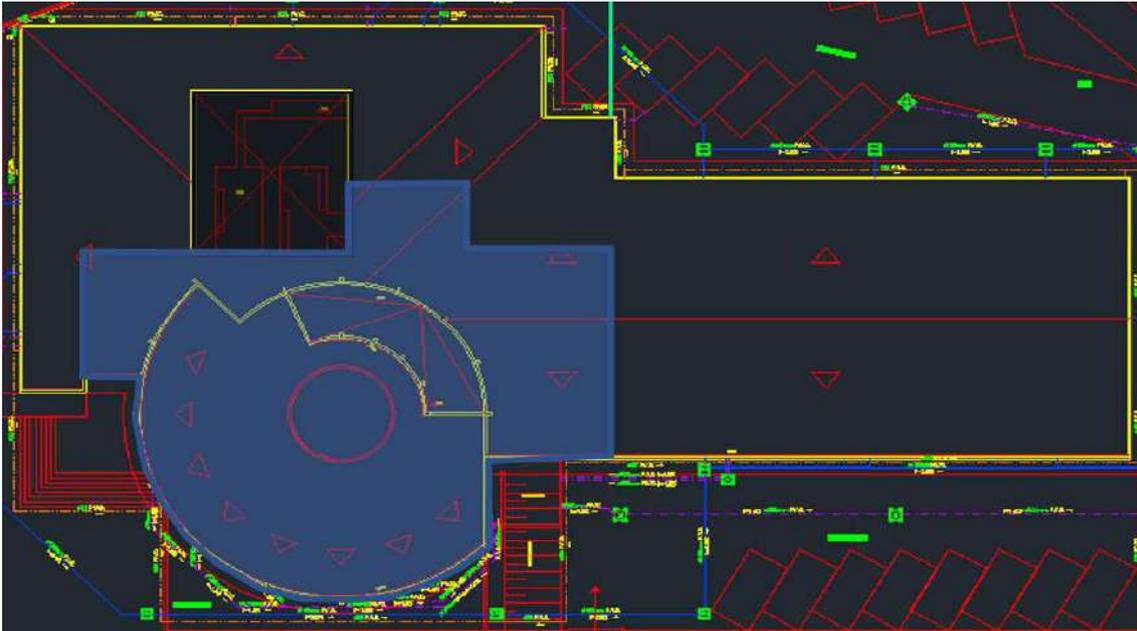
Área em Azul a ser considerada (forro) para troca de telhado (telhas trapezoidais tipo sanduiche) - Área total de 544 m²
